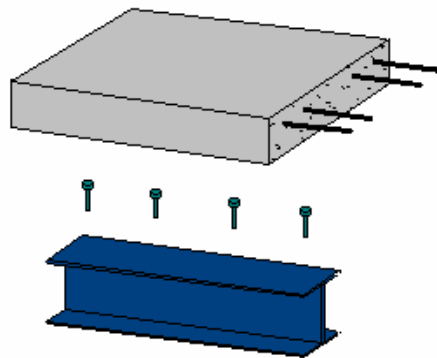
Ligação de cisalhamento entre a laje de concreto e a viga de aço
